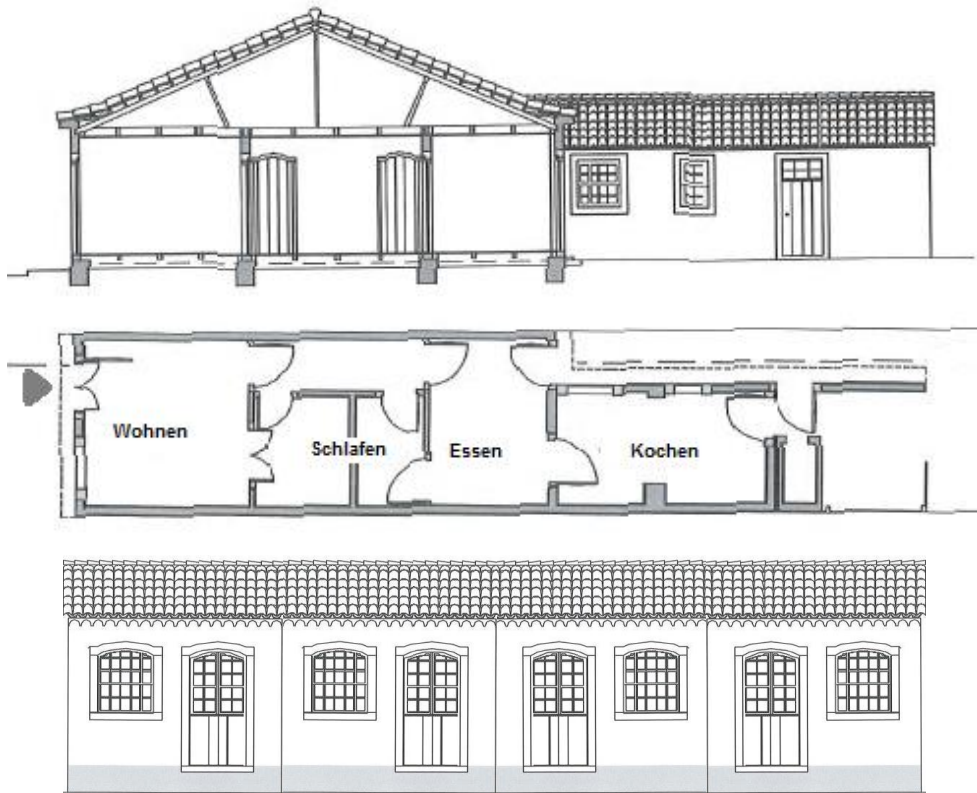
Grundriss, Schnitt und Ansicht eines Kolonialhauses „Casa Térrea“ [BROSS, 2002; S. 135 f.]
